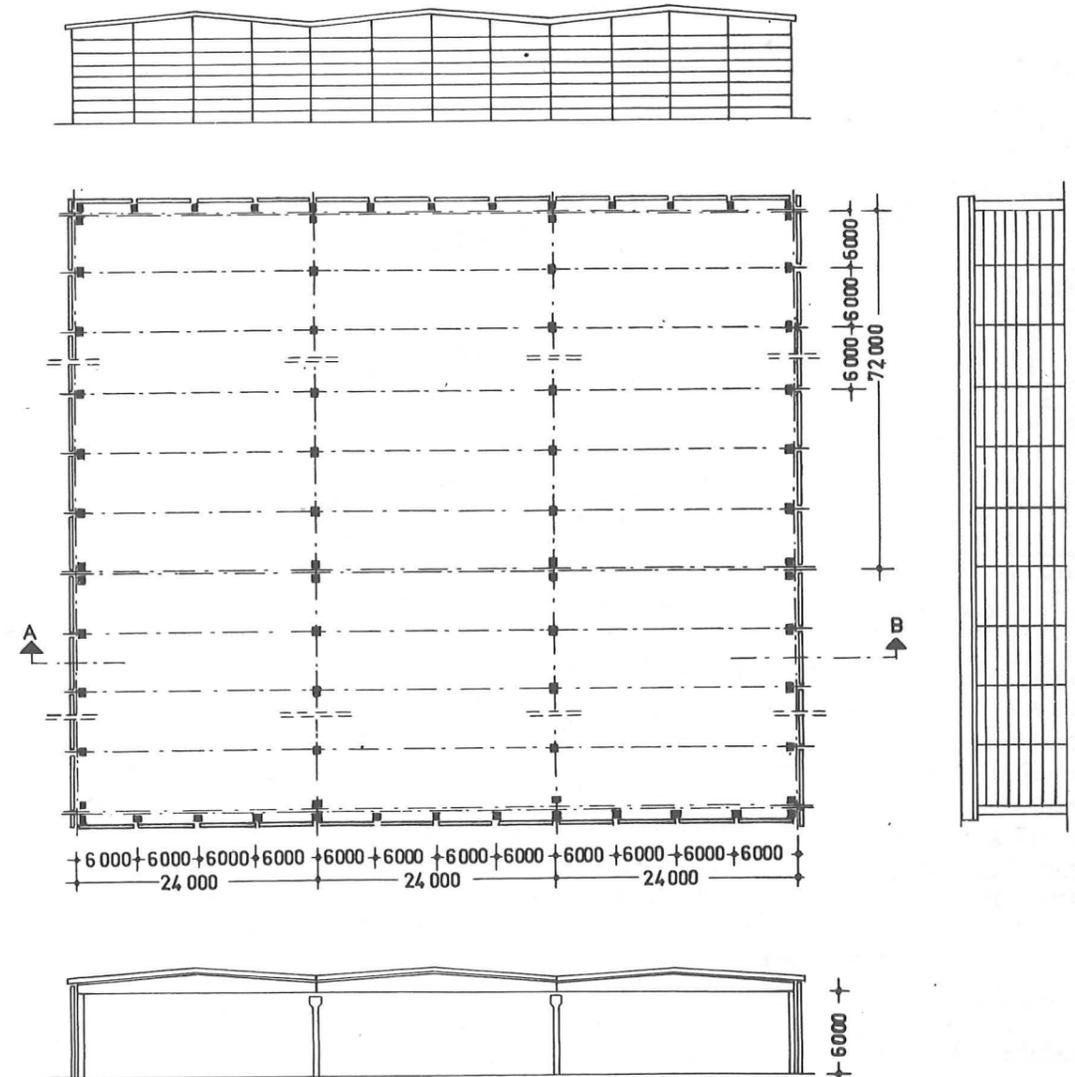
Eingeschossige Gebäude mit Satteldach, Achsabstand 6000 mm,
